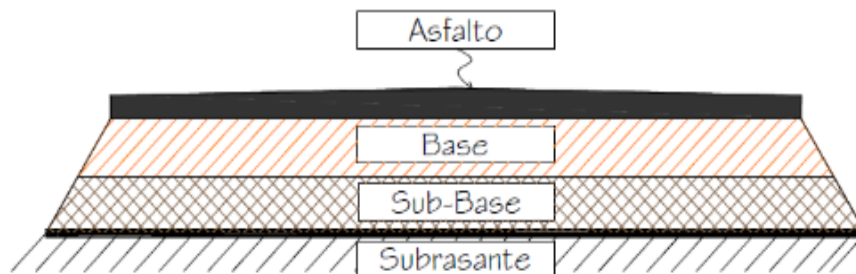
Sección típica transversal pavimento flexible - Fuente: Armijos 2009
